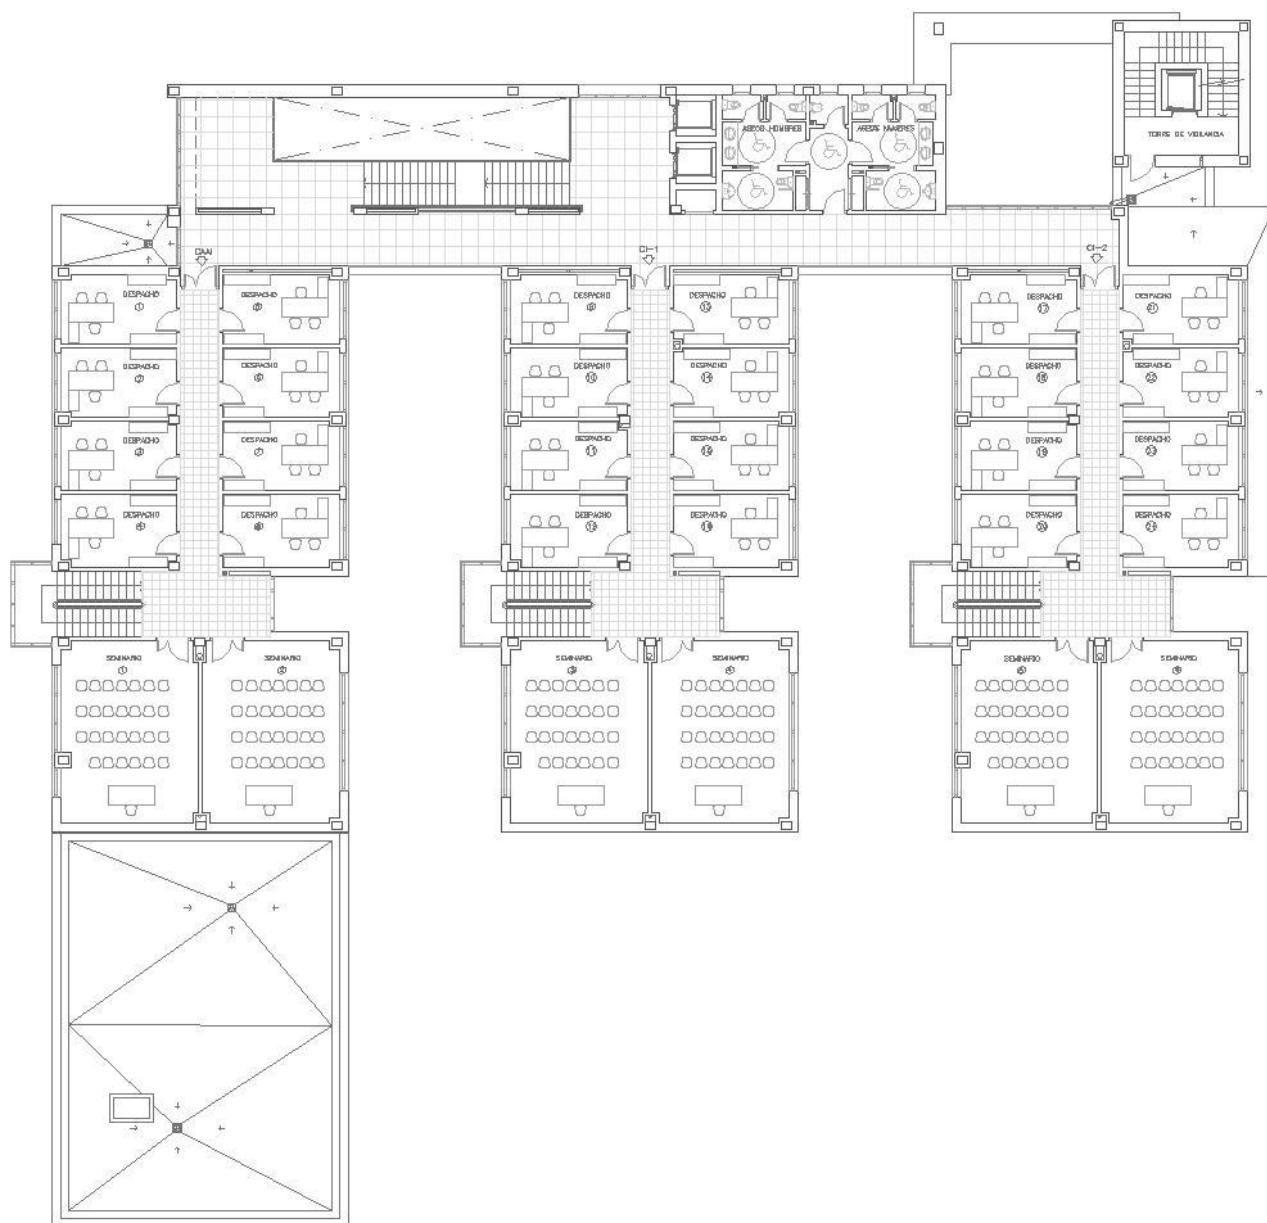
Planta primera. Fuente: Proyecto técnico de ejecución.
